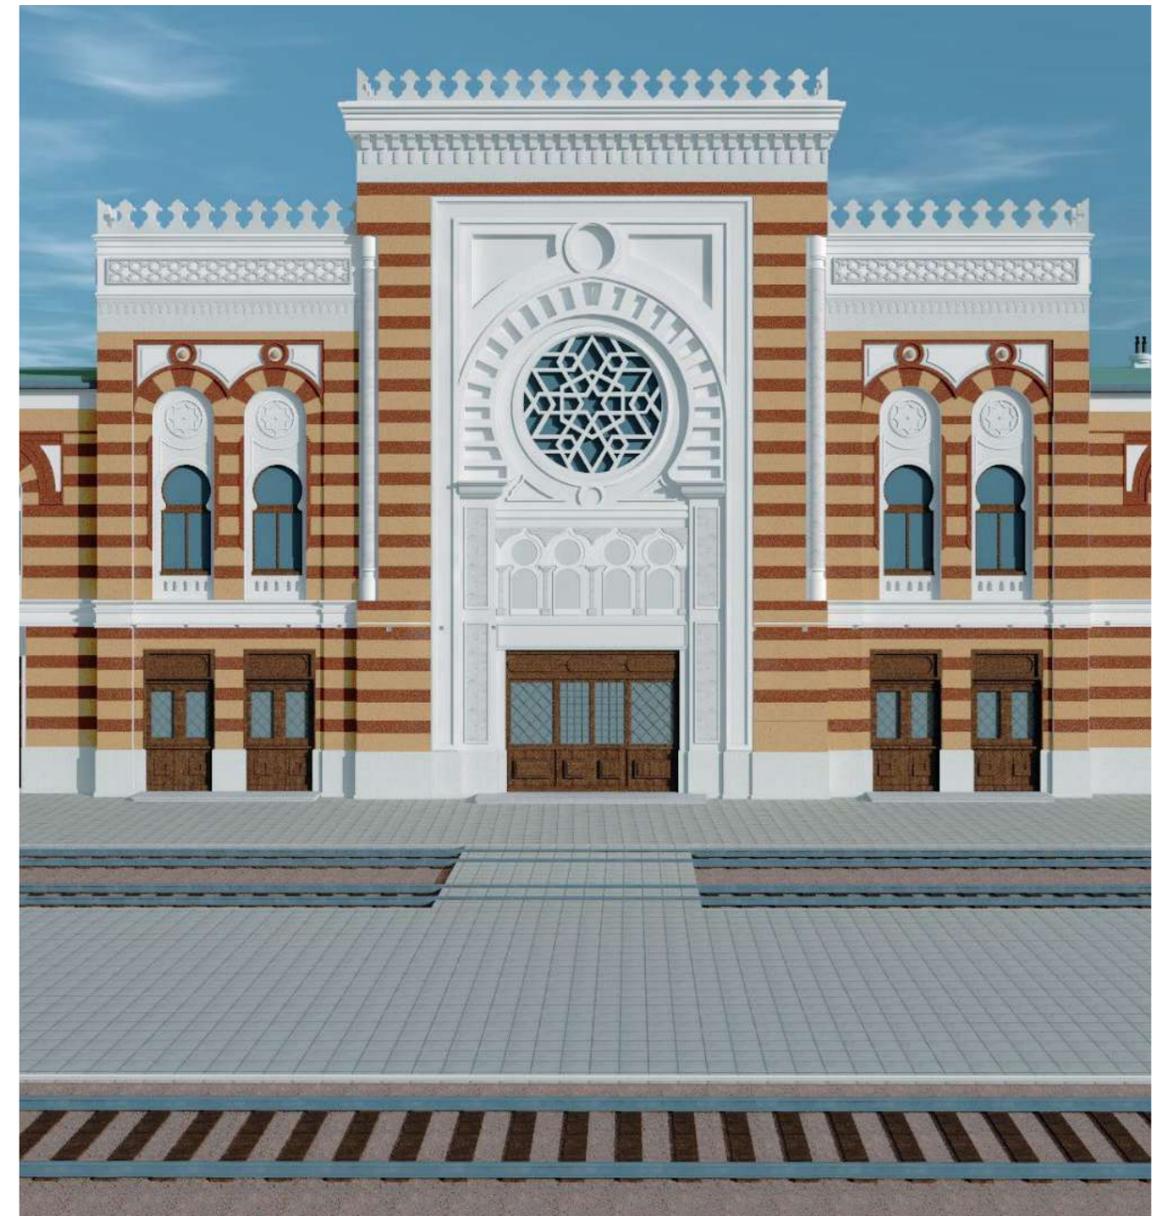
Rekonstruktion Südfassade Haupteingang, Visualisierung (ohne Bahnsteigüberdachung)
